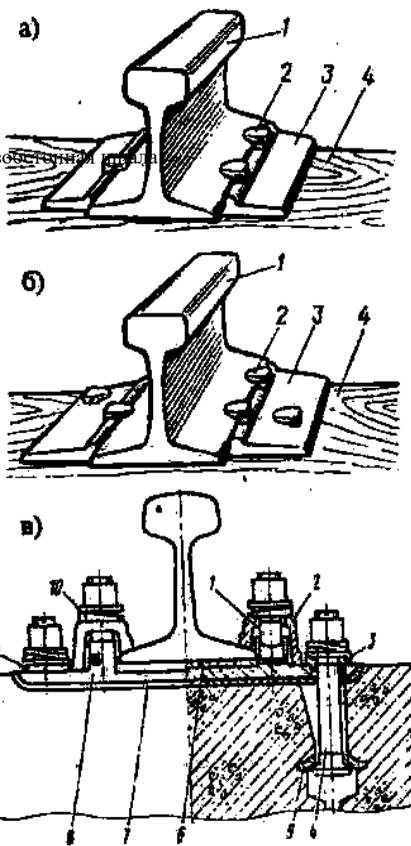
Промежуточные скрепления: а) нераздельное и б) смешанное для деревянных шпал: 1 – рельс; 2 – костыль; 3 – подкладка; 4 – шпала; в) раздельное скрепление типа КБ для железобетонных шпал: 1 – клеммный прижимной болт; 2 – клемма; 3 – изолирующая втулка; 4 – закладной болт; 5 – анкерная шайба; 6 – прокладка; 7 – резиновая подкладка; 8 – подкладка металлическая; 9 –
